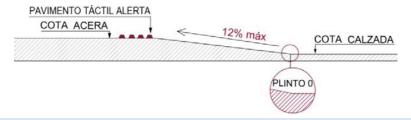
Detalle de encuentro de la rampa entre vereda y calzada donde el plinto debe ser igual a cero.
